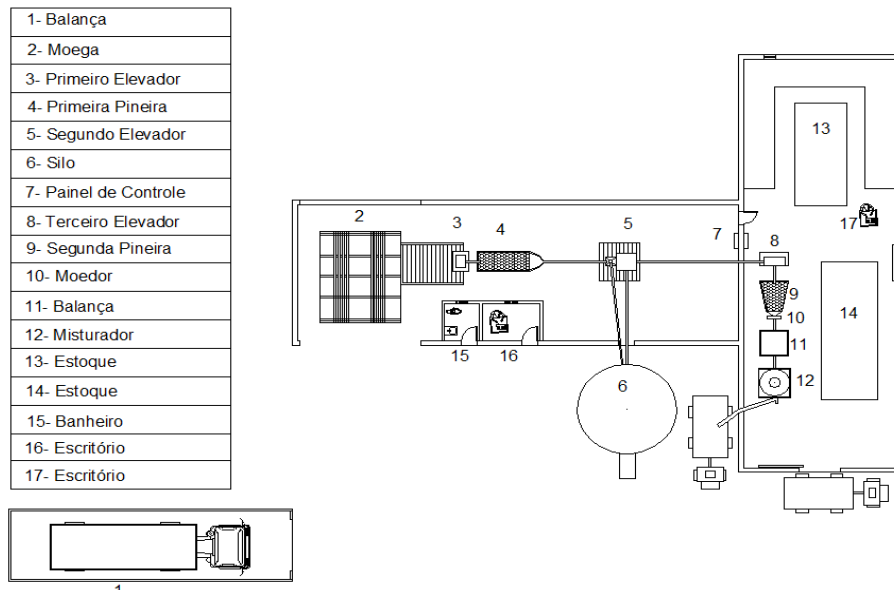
Layout da fábrica de ração do IFMG- campus Bambuí
